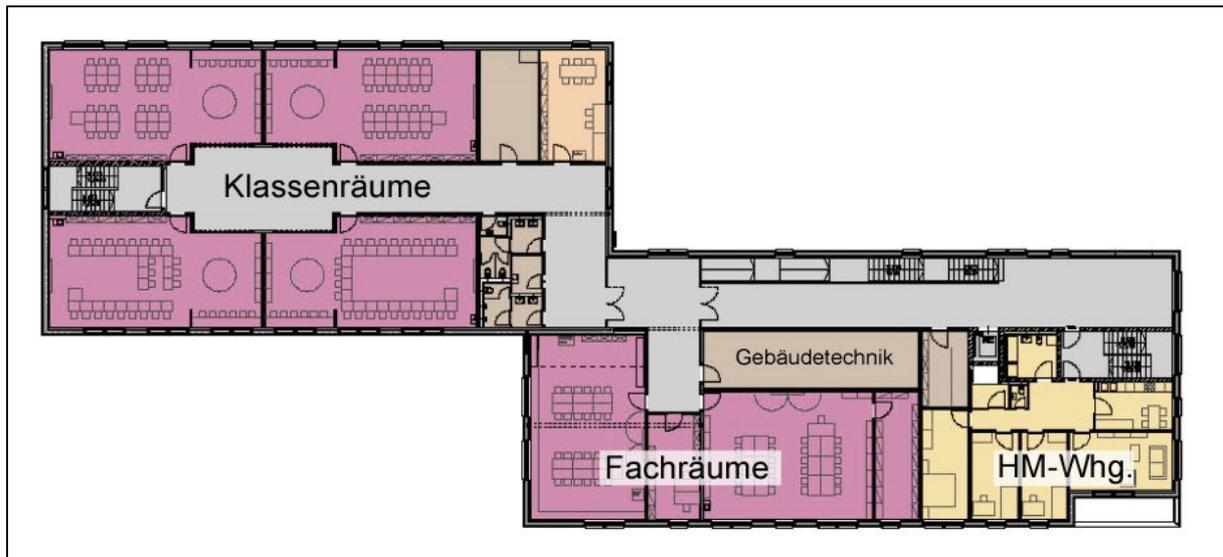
Grundriss 2. OG mit Nutzung
